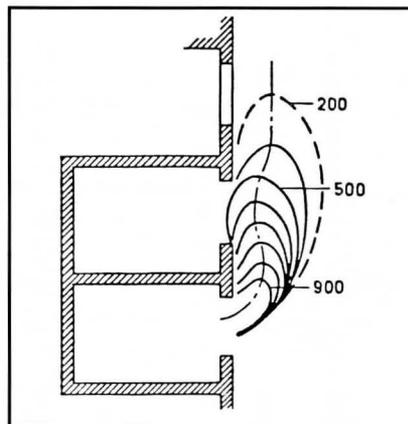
Isothermenverlauf, wenn sich über dem Brandraumfenster eine Öffnung befindet. Kein Wind [2].
